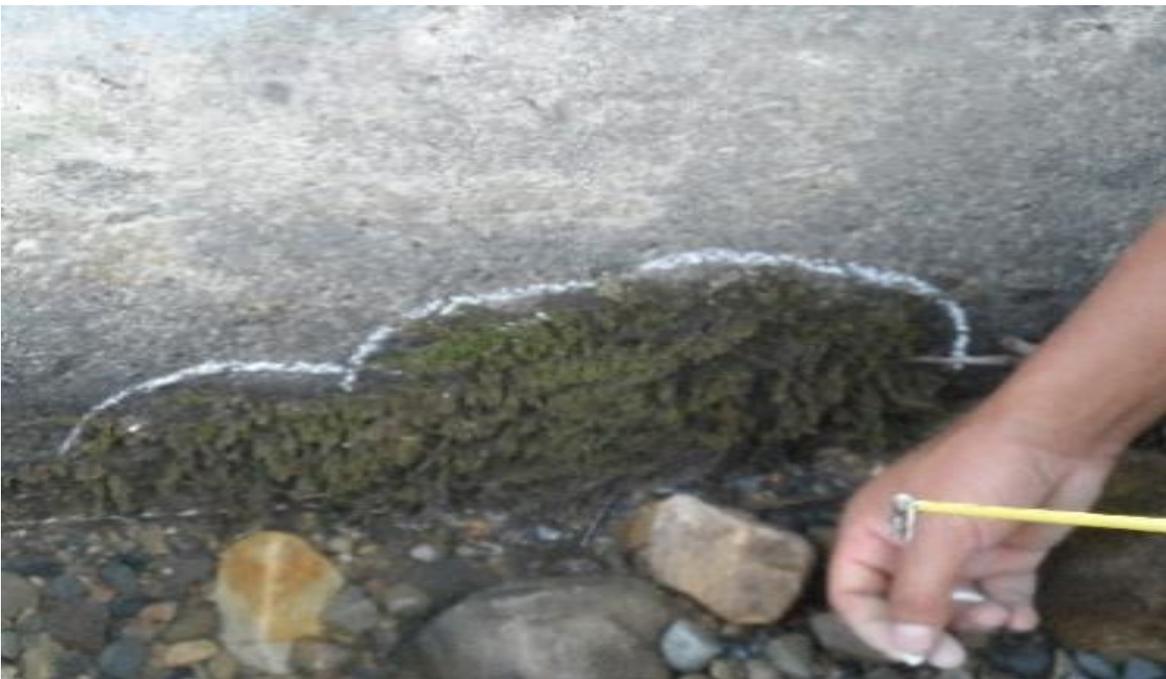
Se observa una grieta en la sección del canal
